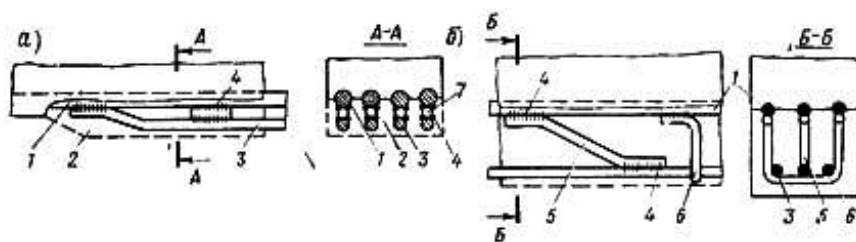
Усиление железобетонных балок путем постановки дополнительной арматуры: а – с приваркой стержней через коротыши; б – с приваркой каркаса; 1 – существующая арматура; 2 – зона усиления; 3 – арматура усиления; 4 – сварка; 5 – наклонный коротыш; 6 – прямой хомут; 7 – коротыш
